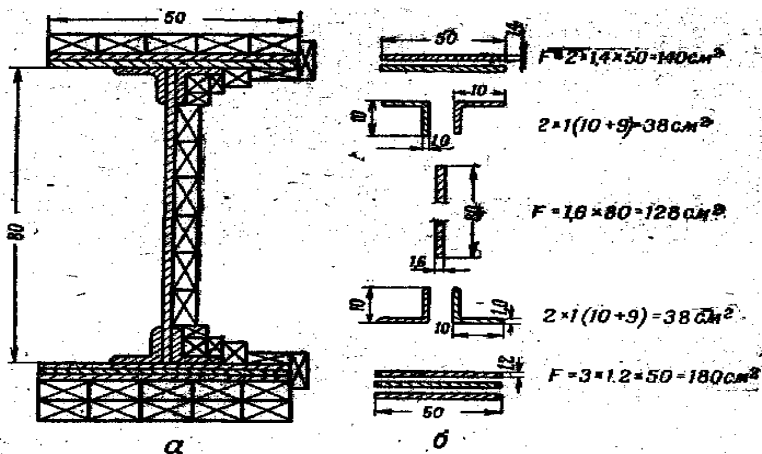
Схема расчета и составления фигурного заряда для взрывания двутавровой стальной балки: а – поперечный разрез балки с расположением шашек ВВ (крепление не показано); б – схема вычисления площадей поперечного сечения элементов балки
